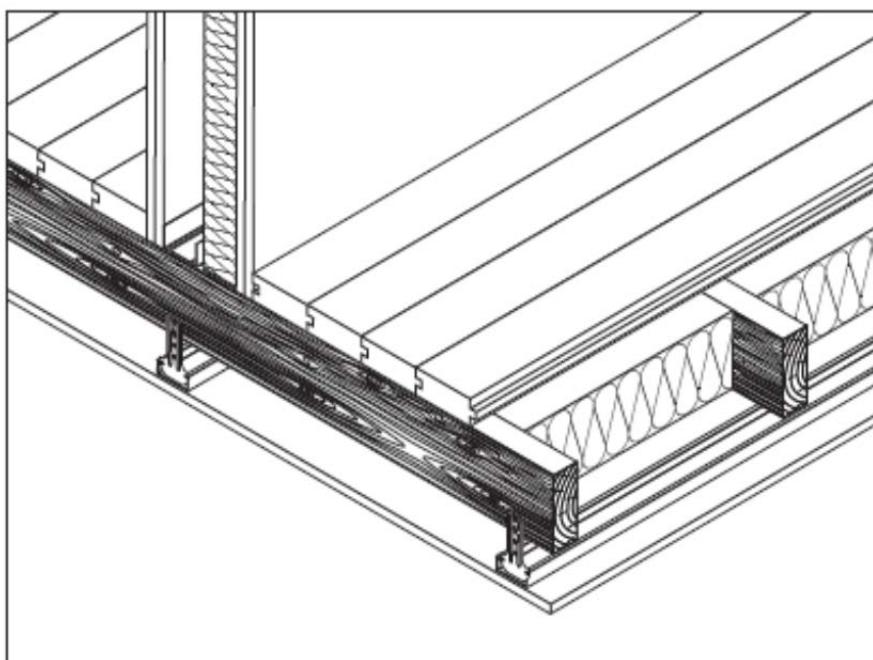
Raccordement sur plancher bois avec interruption du plâtrage pour suppression des transmissions latérales.
